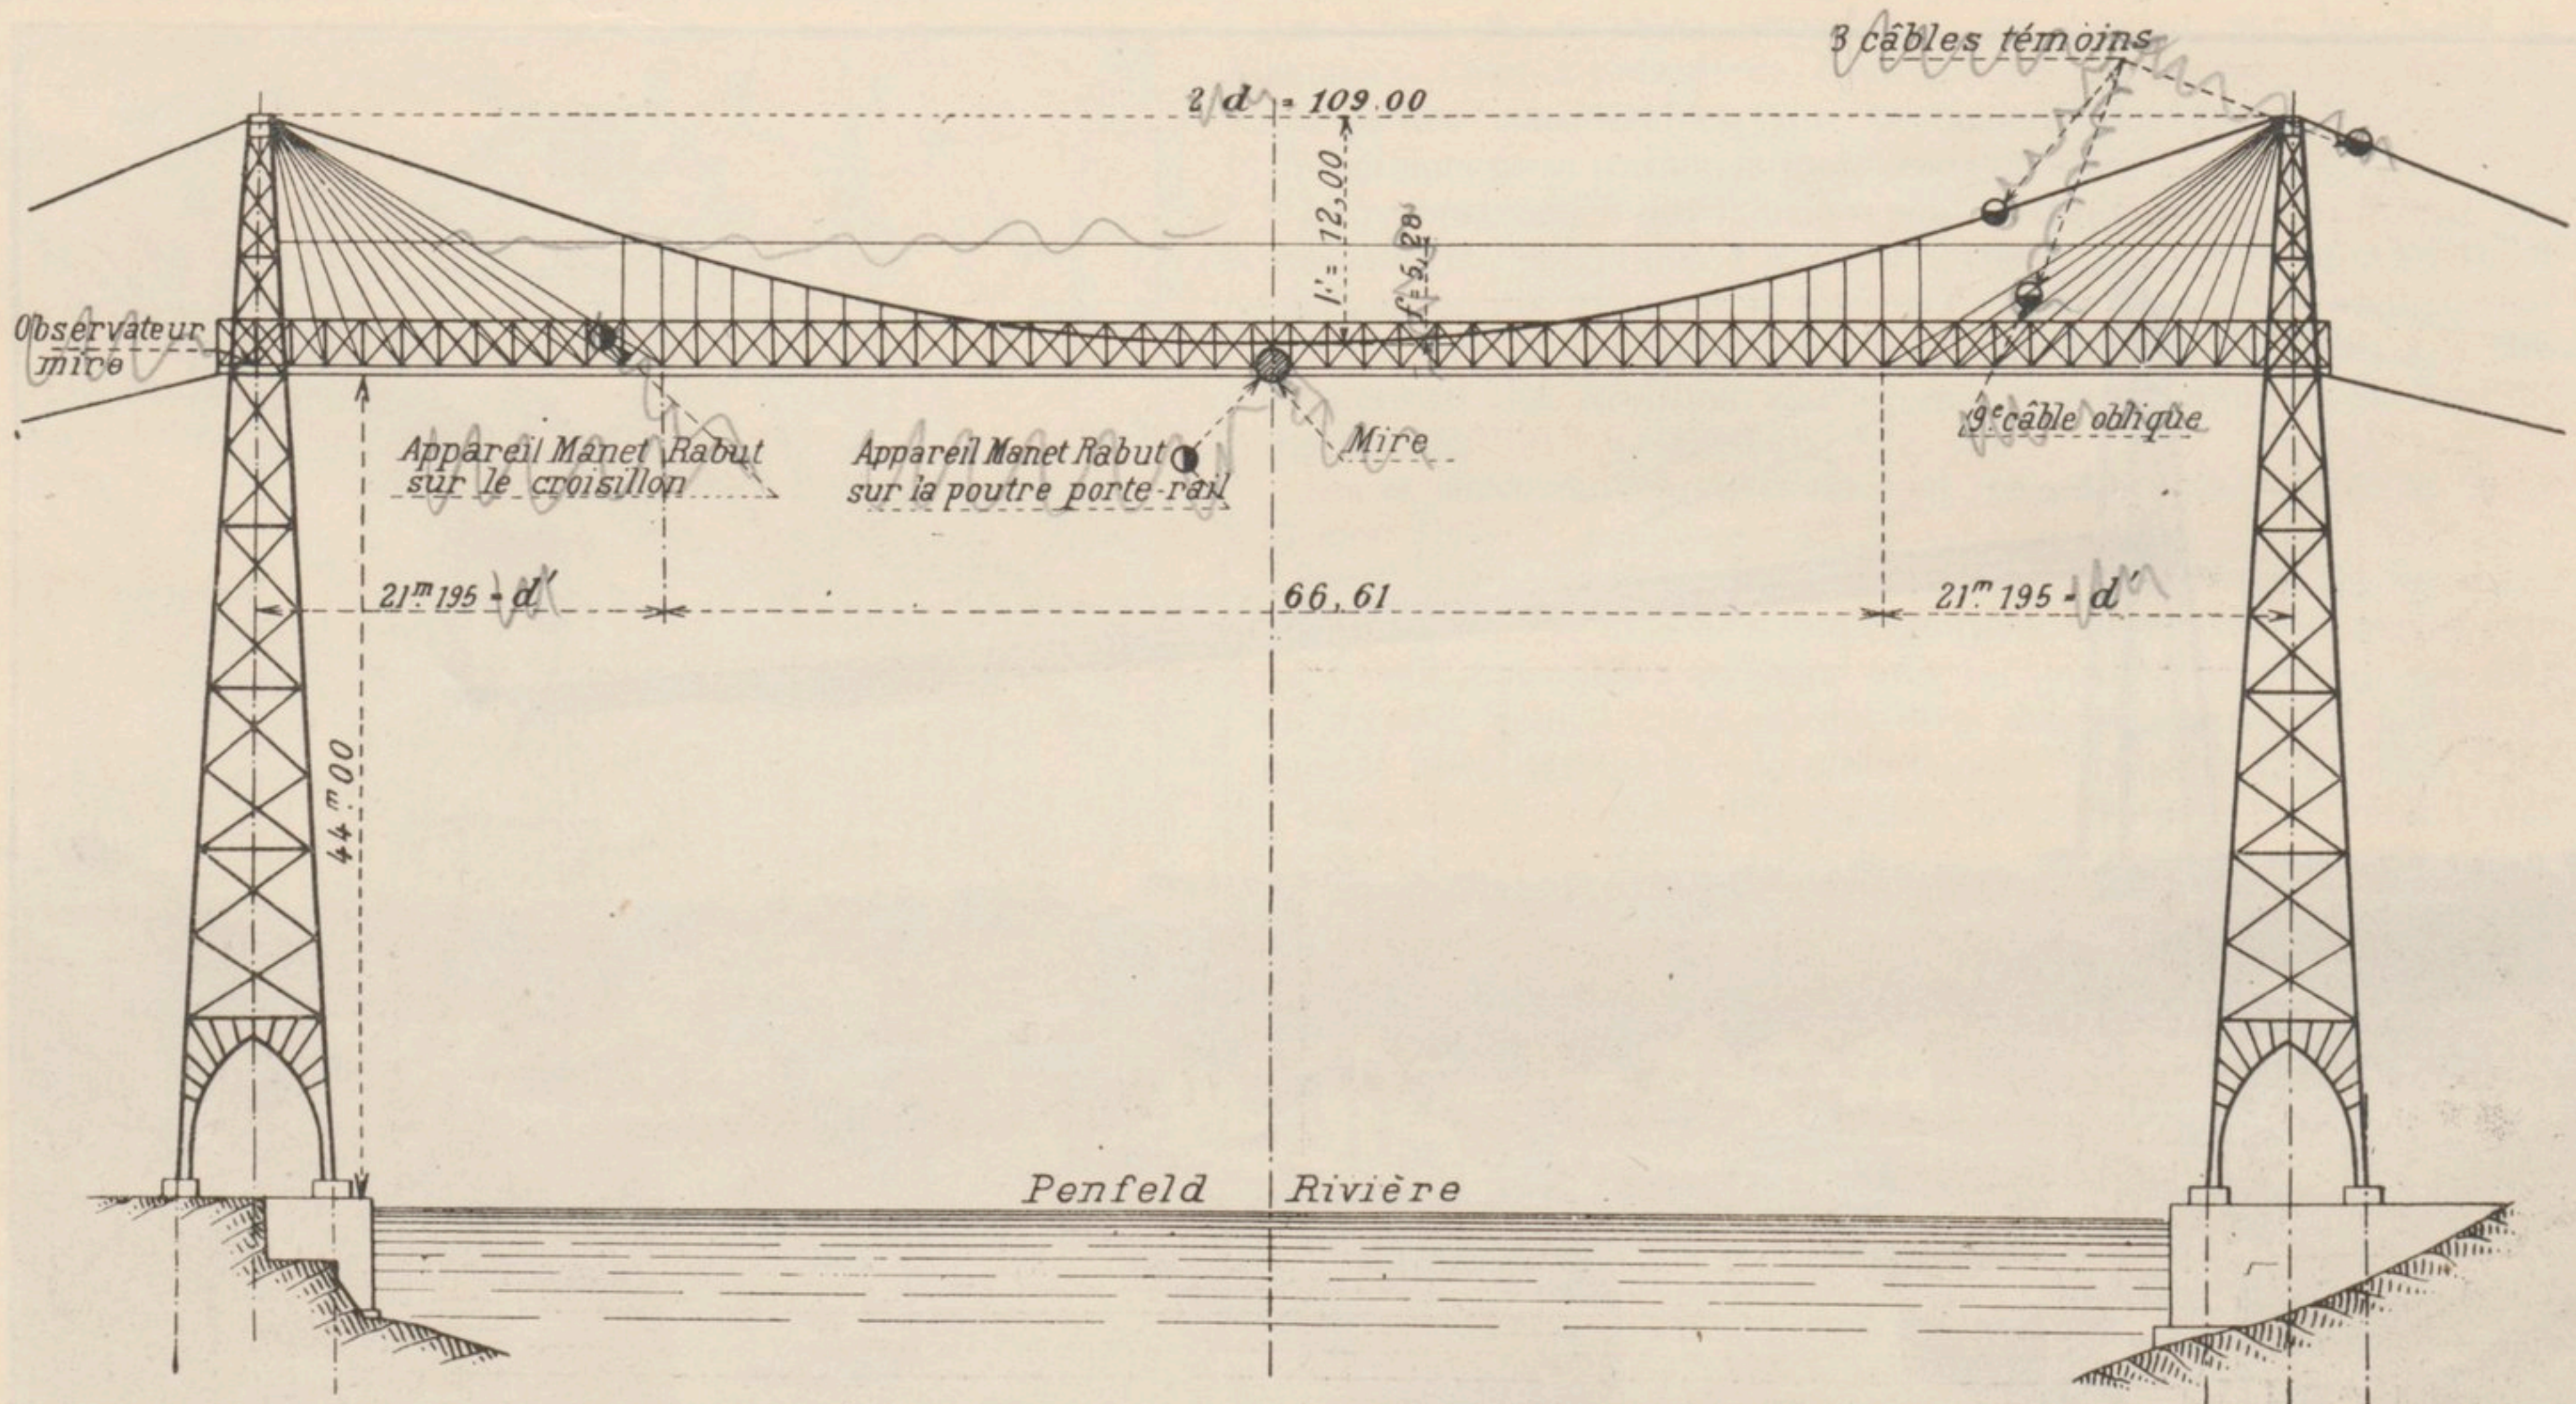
Élévation du pont montrant la disposition des appareils d'essais.
